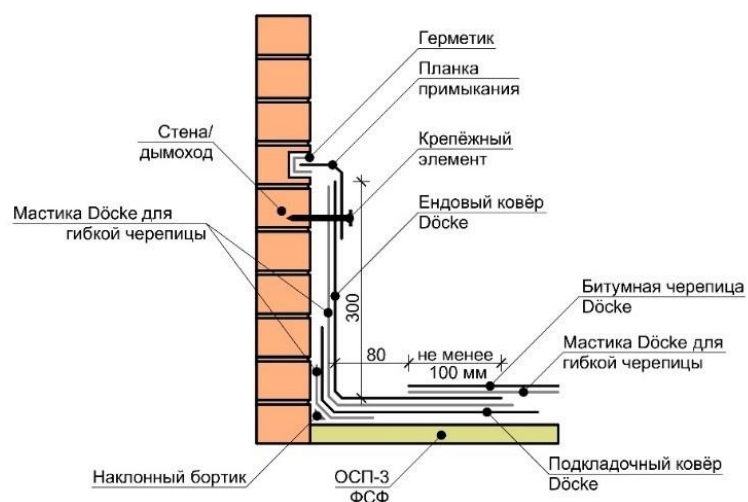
Примыкание ската крыши к выступающим над ней конструкциями под углом не более 90° включительно
